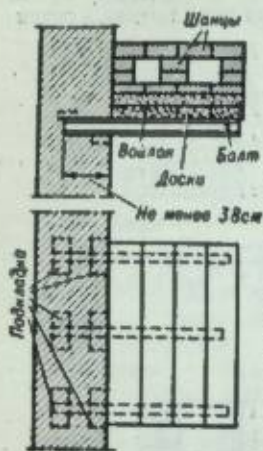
Основание под печь верхнего этажа в каменном здании.
